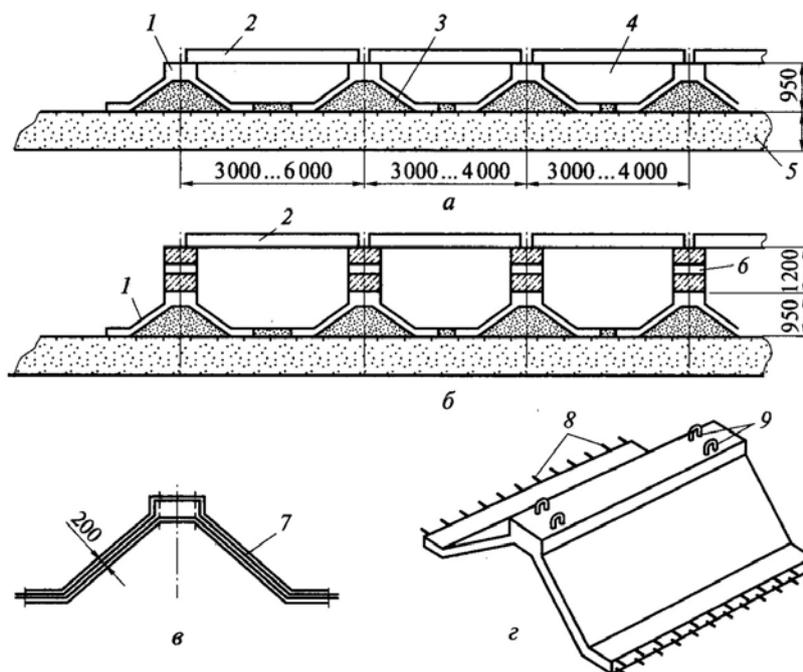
Тип фундамента на вечномёрзлых грунтах:
